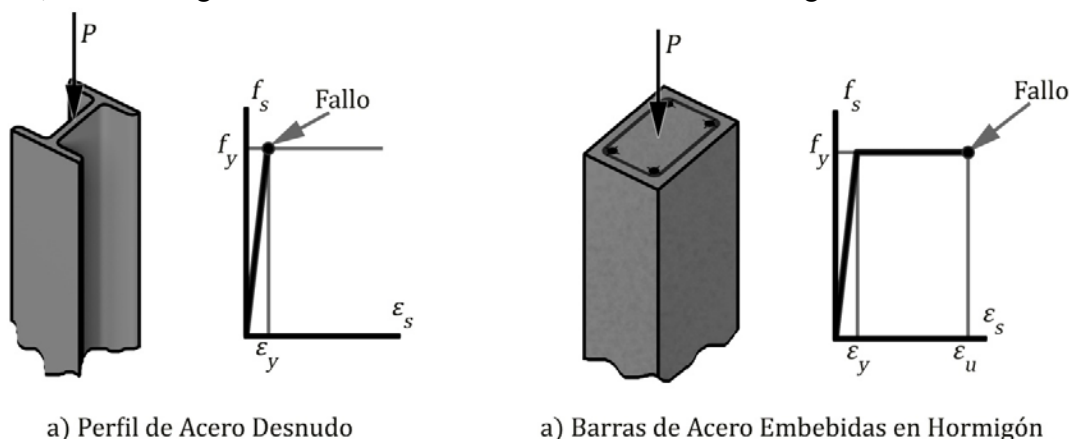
Efecto del hormigón sobre la barra de acero en compresión
